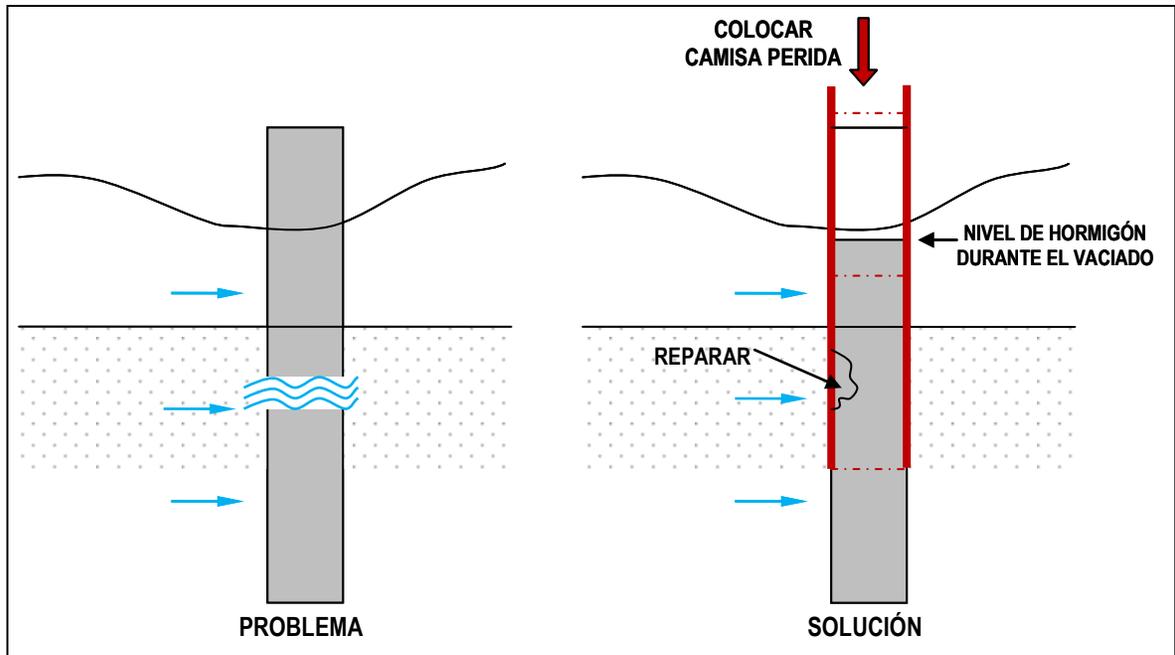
Problema durante la construcción de pilotes por filtración de agua.
